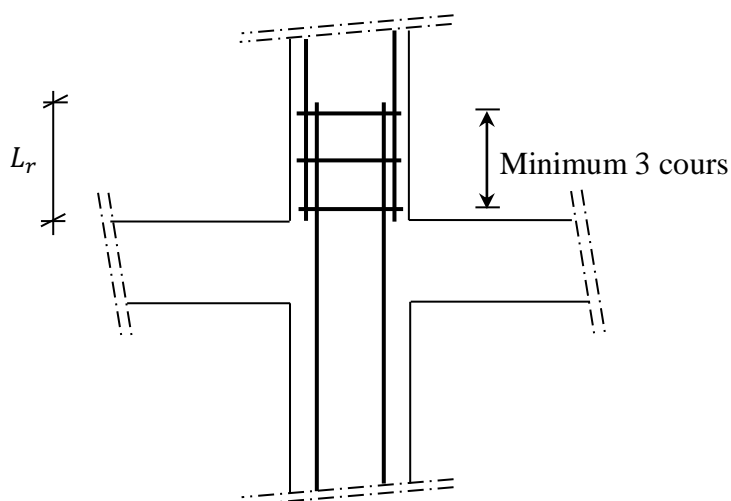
les armatures transversales dans la zone de recouvrement.
